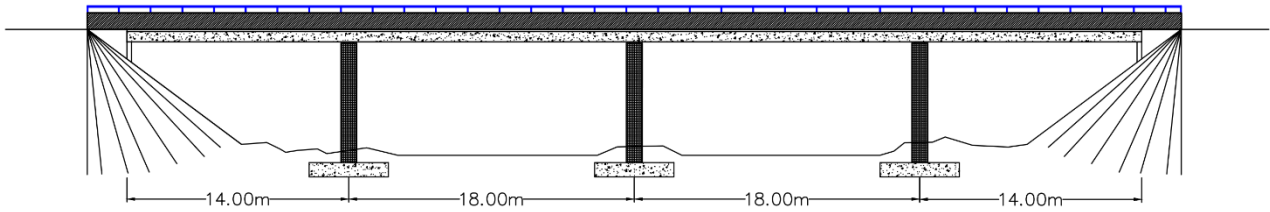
Alzado longitudinal del puente de 64 metros longitud, con luces de 14m y 18m.
